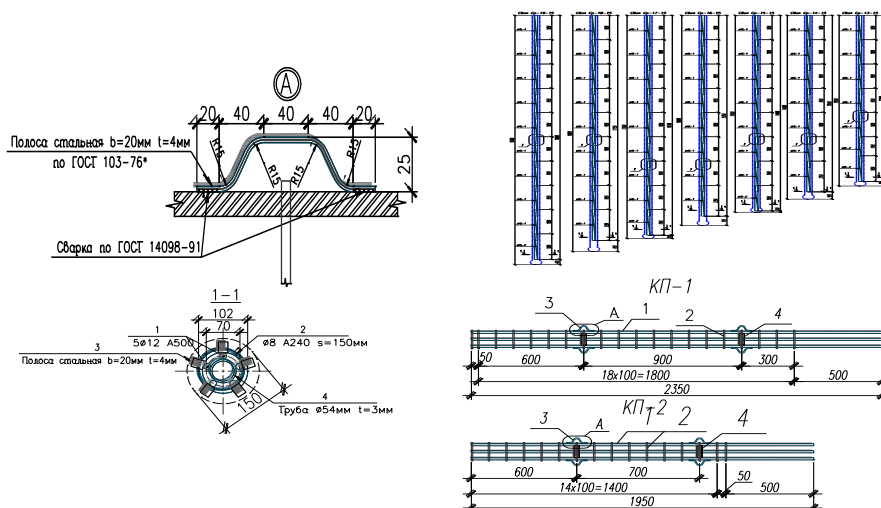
Армирование буроналивных свай. 1 – продольная арматура; 2 – поперечная арматура; 3 – фиксатор; 4 – элемент жесткости каркаса.
